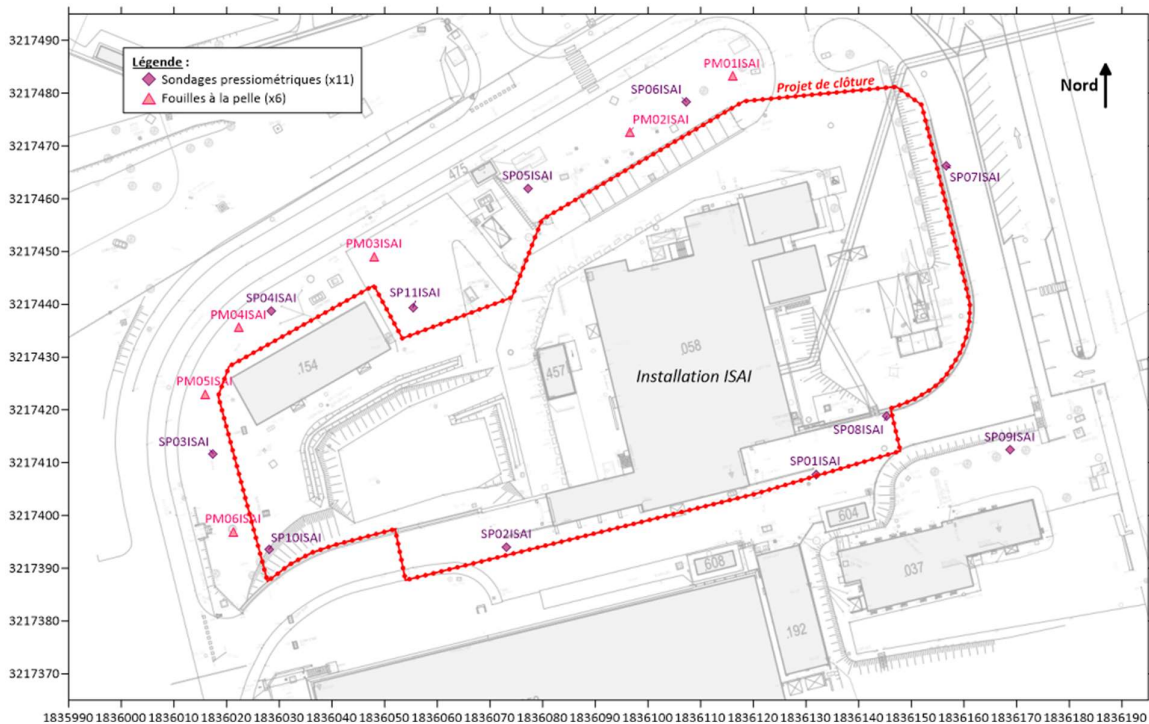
Plan d'implantation des sondages d'ABO ERG par type d'essai
